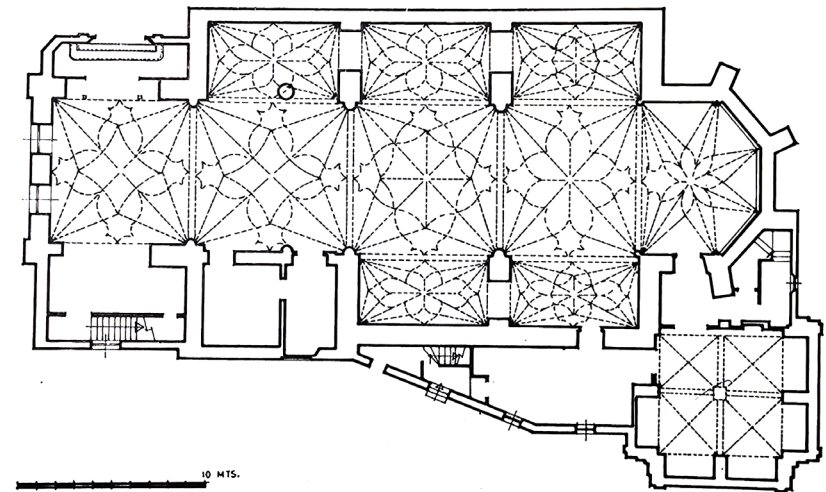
Planta de la iglesia parroquial de Milagro (García et al. 1985, 208).
